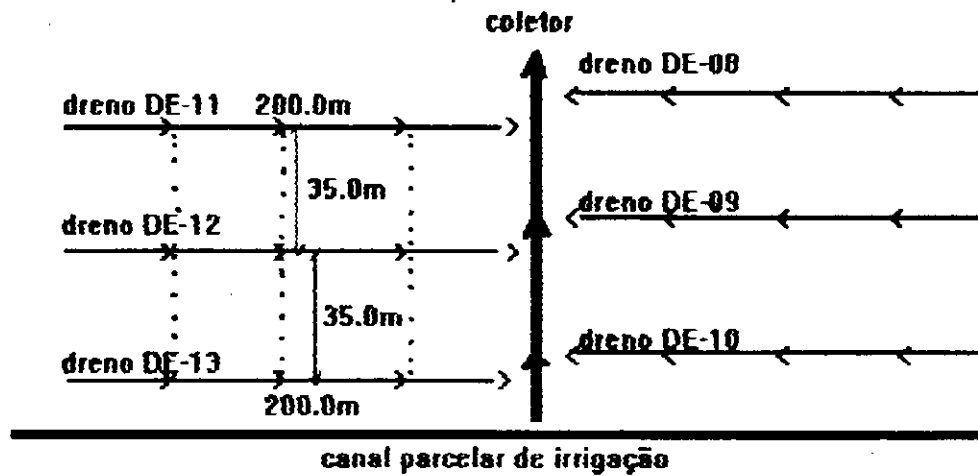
Layout do lote 045 do ensaio 03 do perímetro Bebedouro
